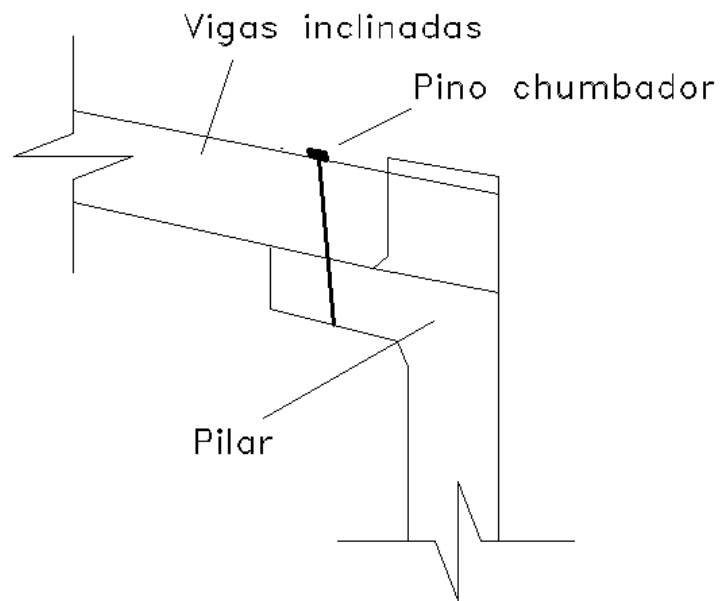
Ligação viga-pilar por encaixe e parafuso.
